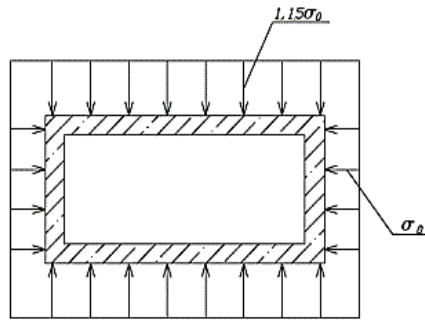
Схема до розрахунку стін опускного колодязя на згин у поперечному перерізі
